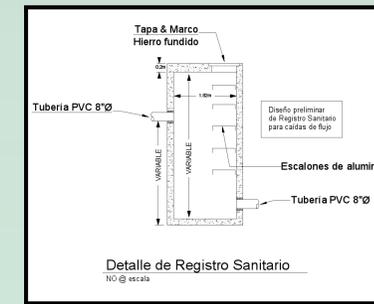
DETALLE DEL ALCANTARILLADO SANITARIO
